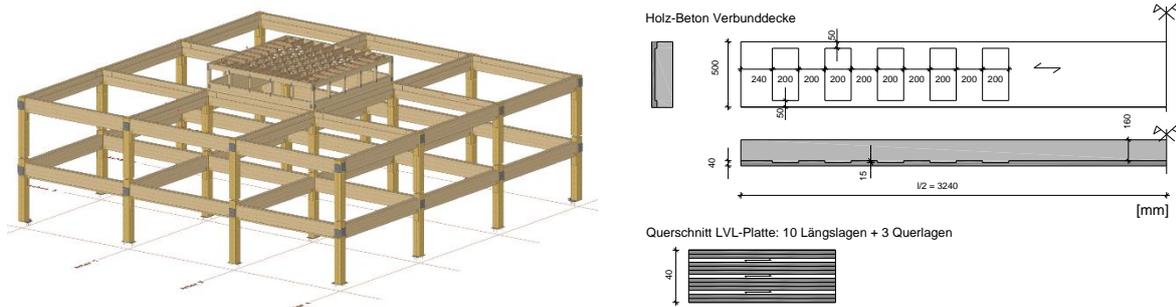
Visualisierung der vorgespannten Holzrahmenkonstruktion des ETH House of Natural Resources (links, Häring & Co. AG) und Geometrie der Holz-Beton-Verbunddecke (rechts)
